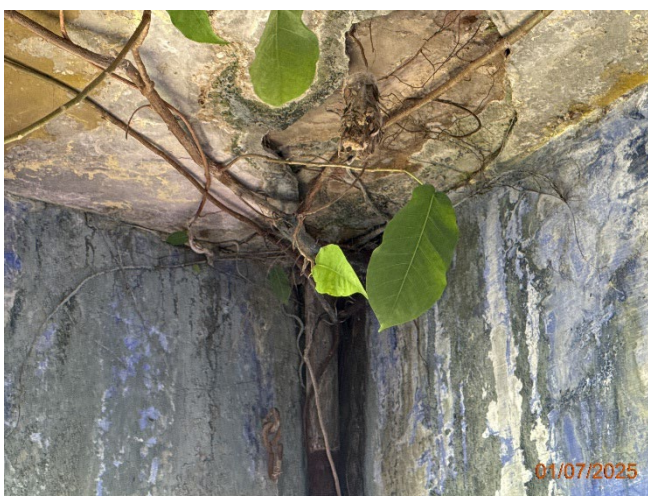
Fissura com percolação de água e eflorescências.
